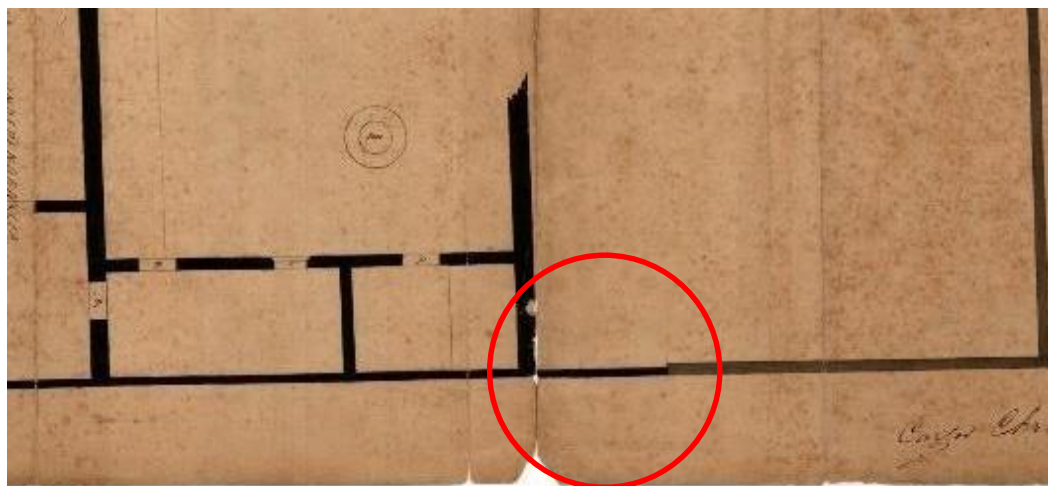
Relevamiento de 1870. Plano N° 1 DGA. Detalle de la impronta de un local desaparecido.
